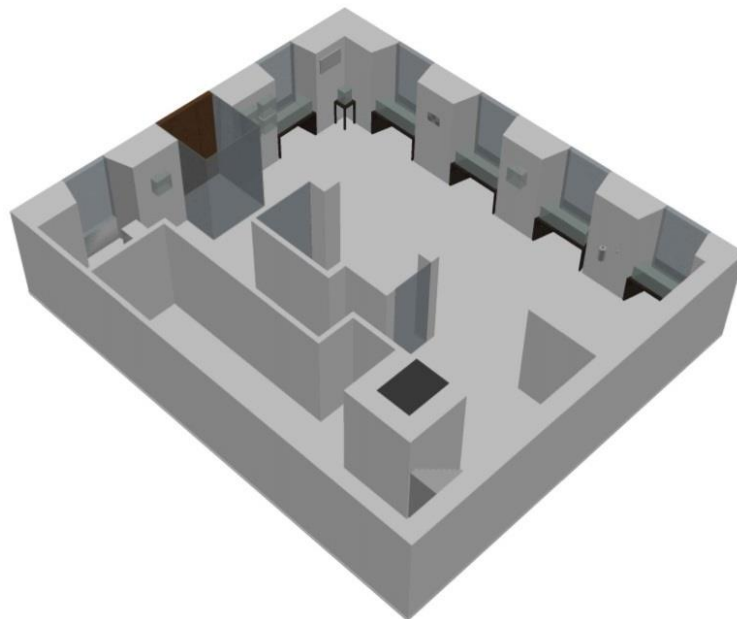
Planta da zona de entrada, recepção e *lobby* do Hotel Abade João, com expositores entre janelas, vista 2, AP, 2014.
